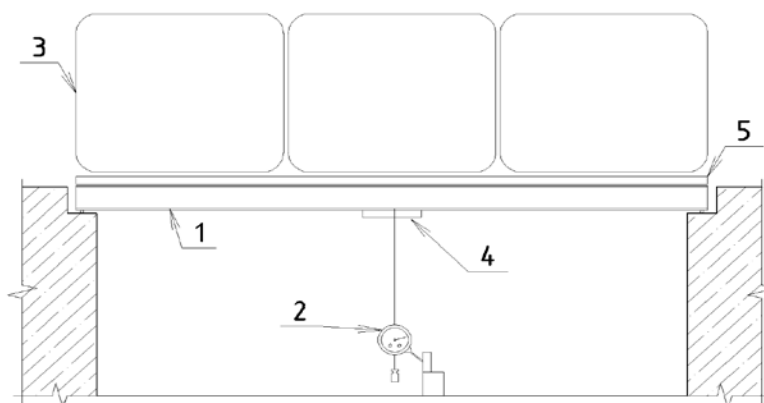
Схема стенда для испытания распределённой нагрузкой
